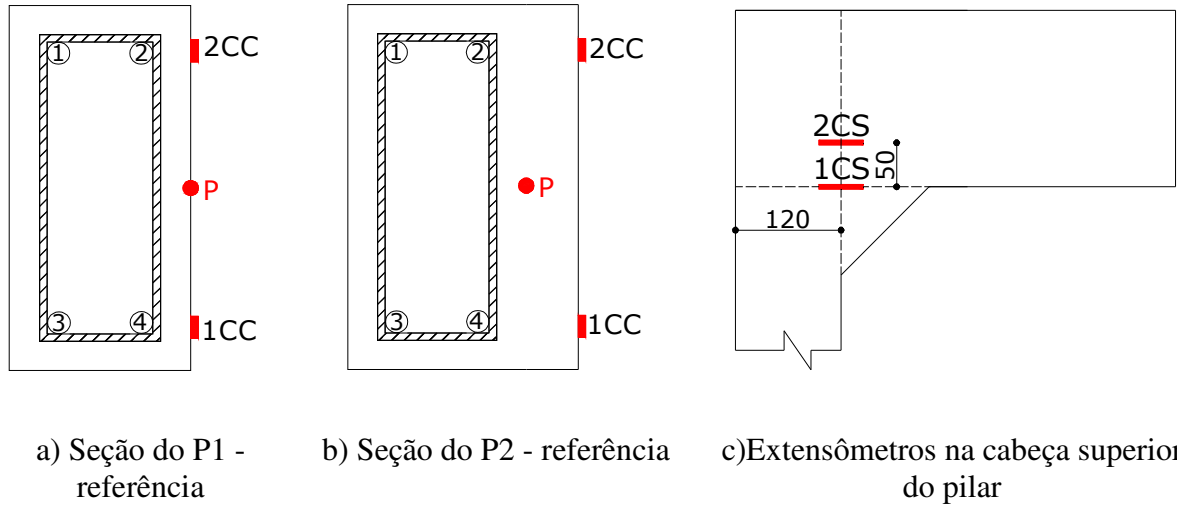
Posicionamento dos extensômetros de concreto nos pilares de referência, unidades em milímetros
